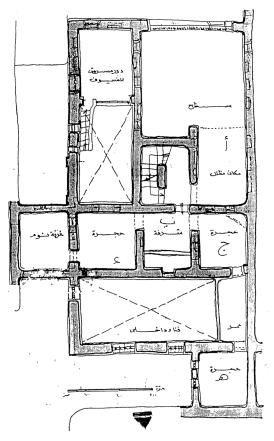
منزل العريف جمال الدين - الدور الأول - مسقط أفقى
